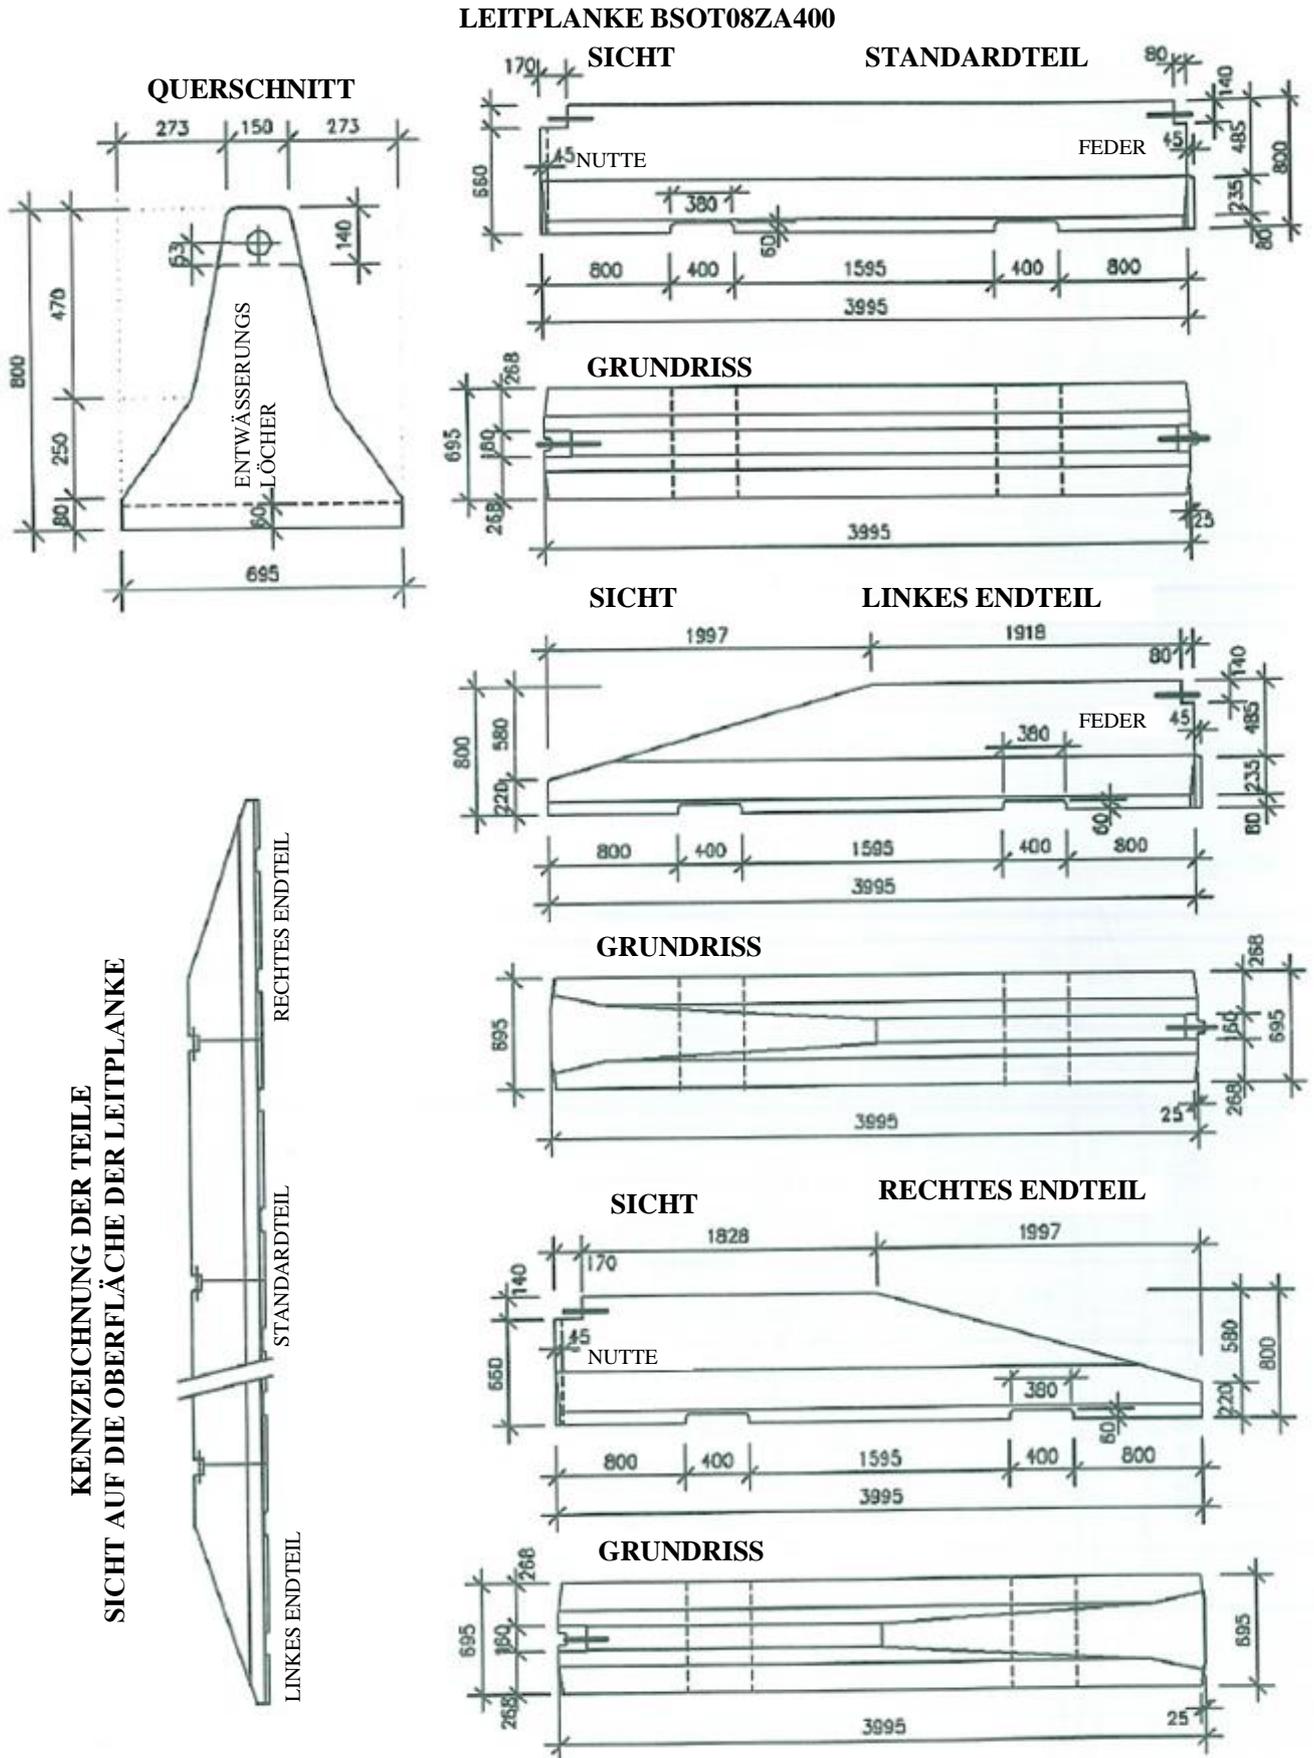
beidseitige Betonleitplanke 0,8 m hoch - Standard- und Endteil
